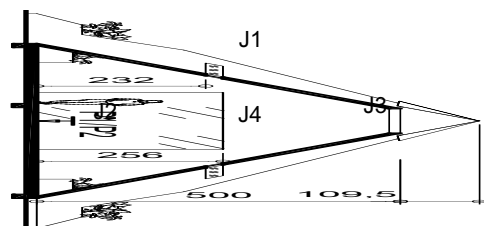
Corte Transversal da edificação proposta. Fonte: Elaborado pelos autores.
